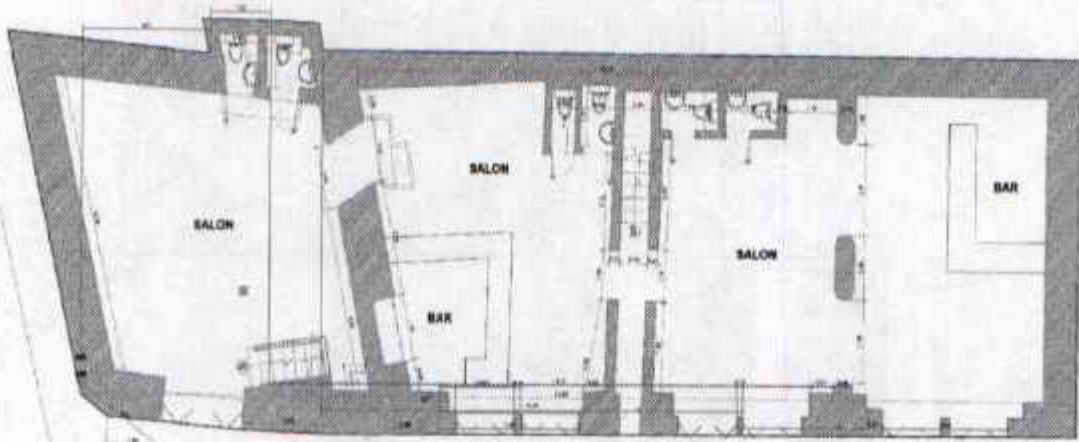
Plano RESTAURANTE BAR DONDE FIDEL - Área privada.
